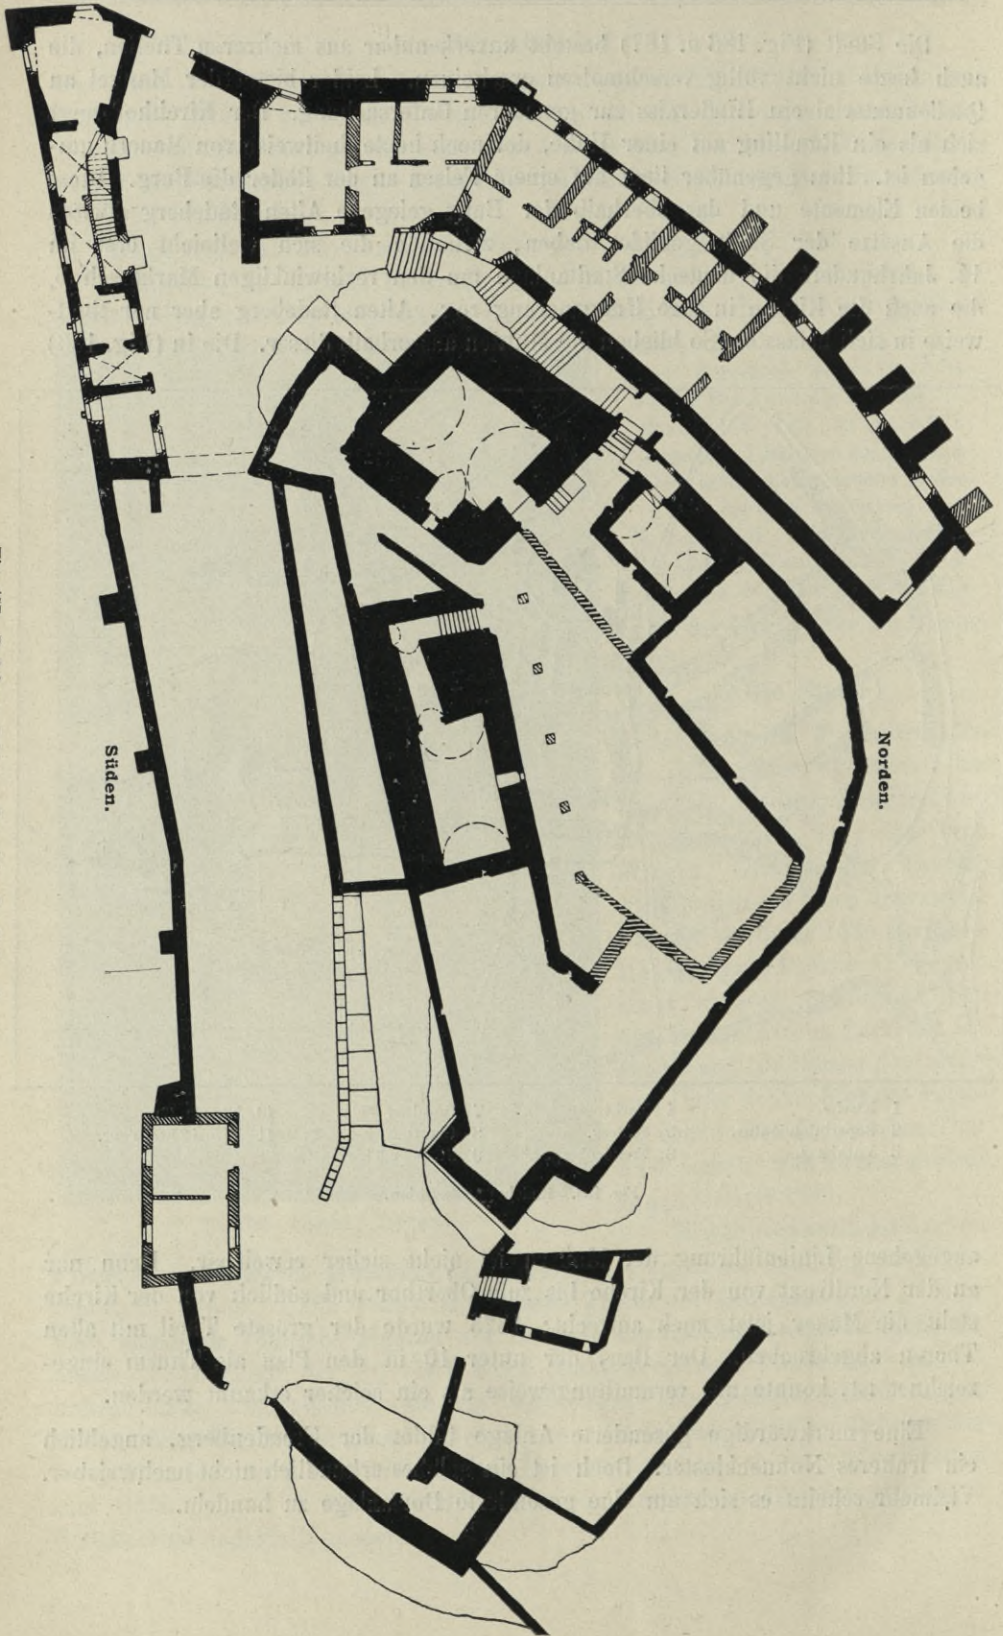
Radeberg, Schloss. Grundriss des Erdgeschosses.
